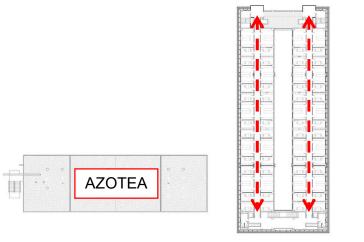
Planta arquitectónica, circulación segundo nivel.
